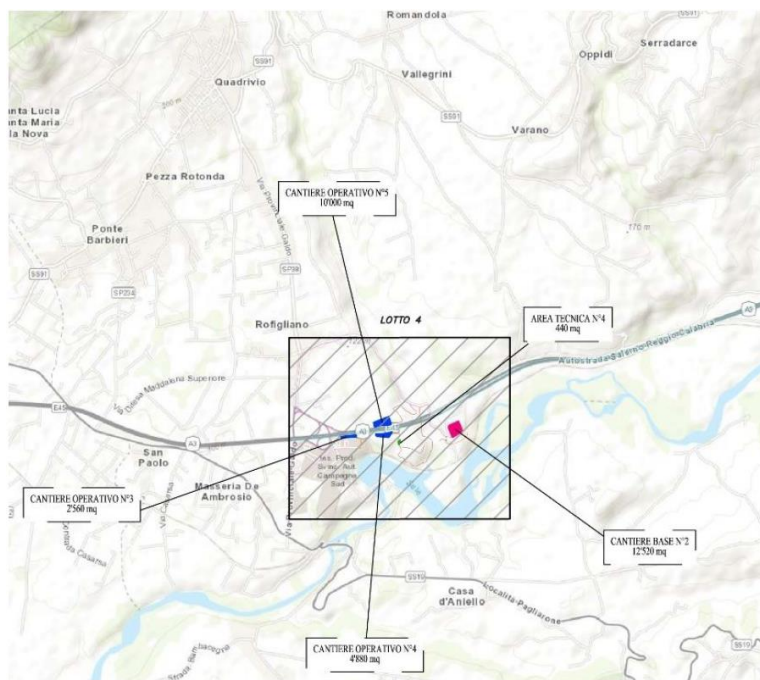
Planimetria con individuazione dei cantieri base, operativi e aree tecniche.
